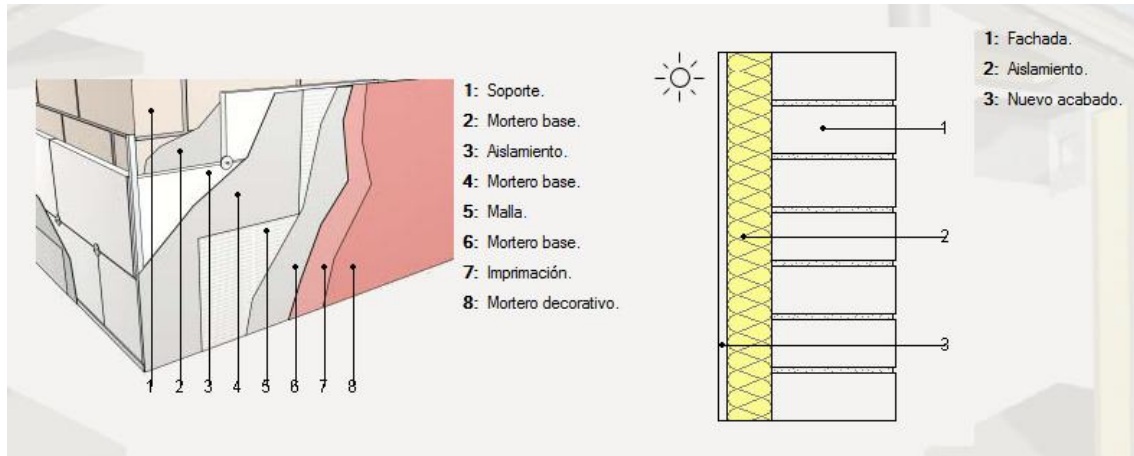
Detalle constructivo: Sistema ETICS. Fuente: Arquímedes
